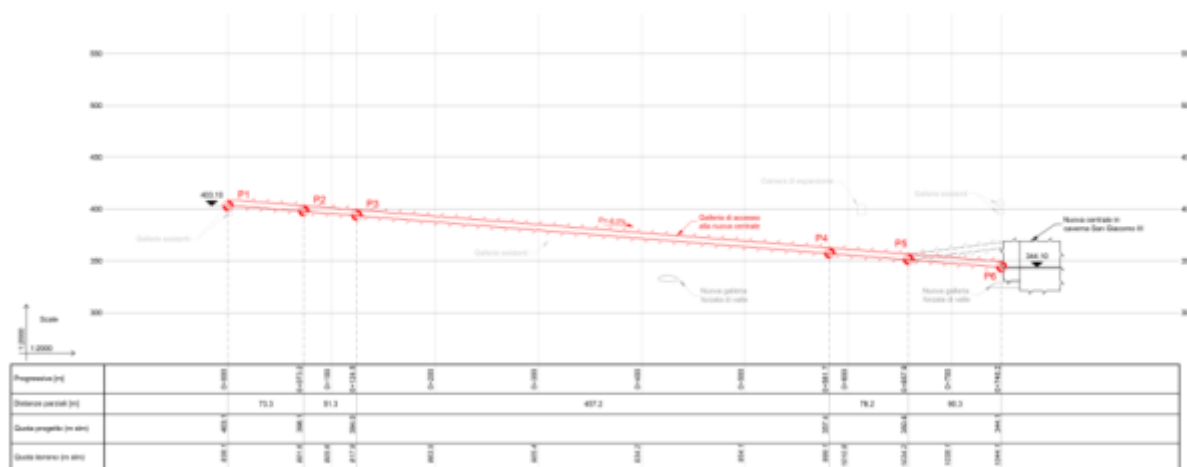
Galleria di accesso alla nuova centrale in caverna – profilo
